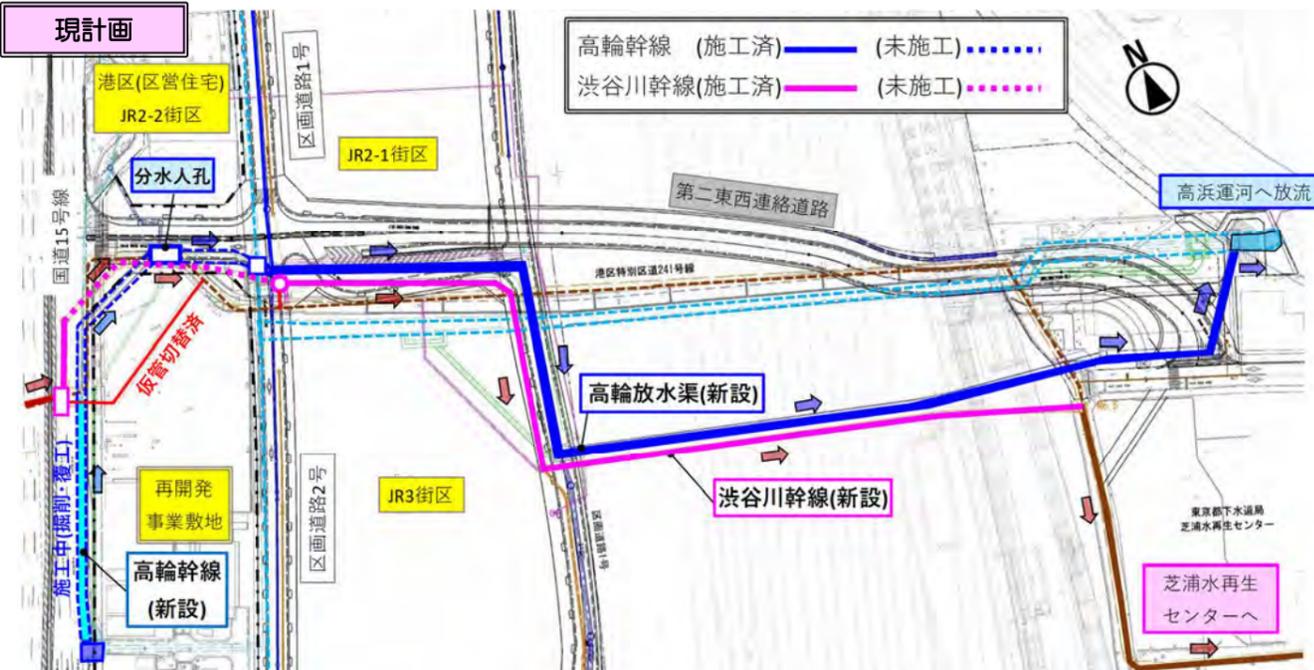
品川駅北周辺地区下水幹線平面図(現計画)
